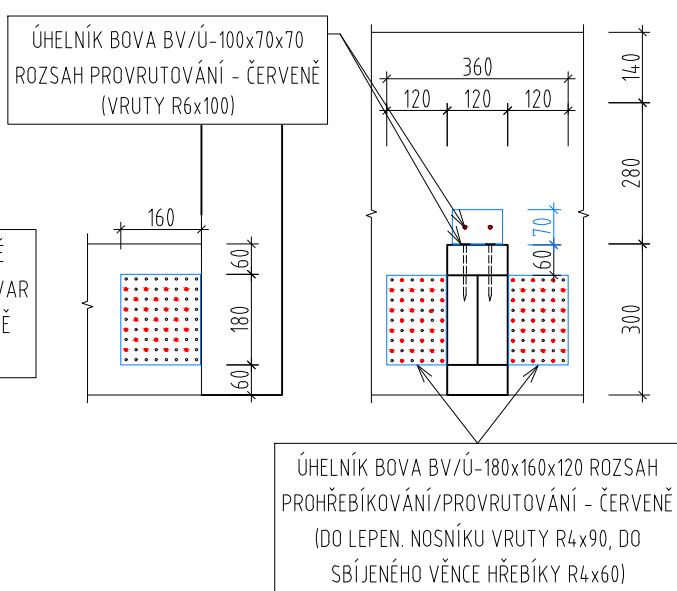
NAPOJENÍ ZAKLÁDACÍCH PRAHŮ
